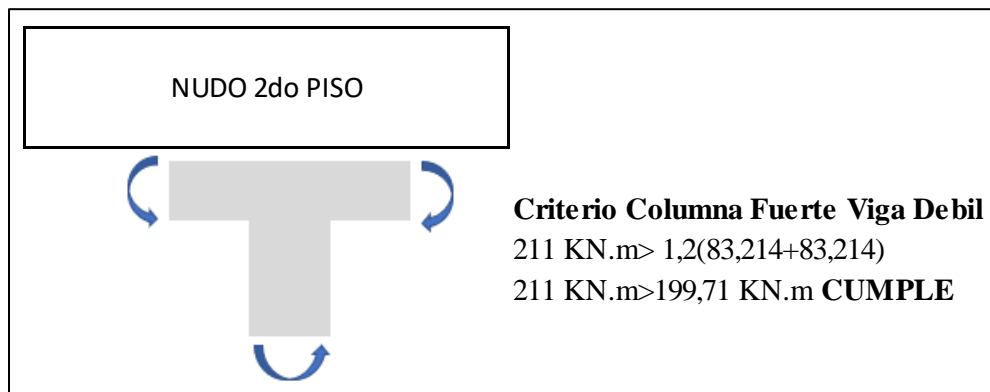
Criterio viga fuerte y viga débil de la columna C1 y C4
